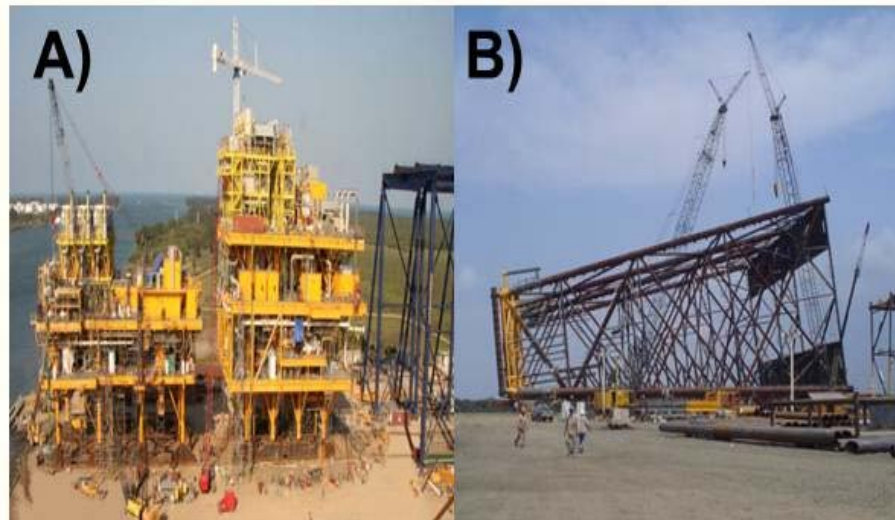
A) Deck (superestructura) y B) Jacket (subestructura), ambas en patio de maniobras.
